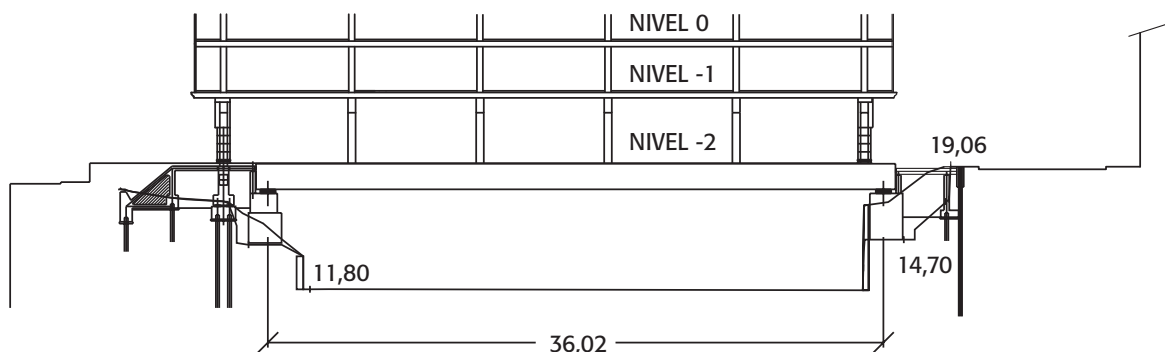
Sección por la viga 6, losa 1 al lado del Pont-Neuf (Av. Charles de Gaulle)
